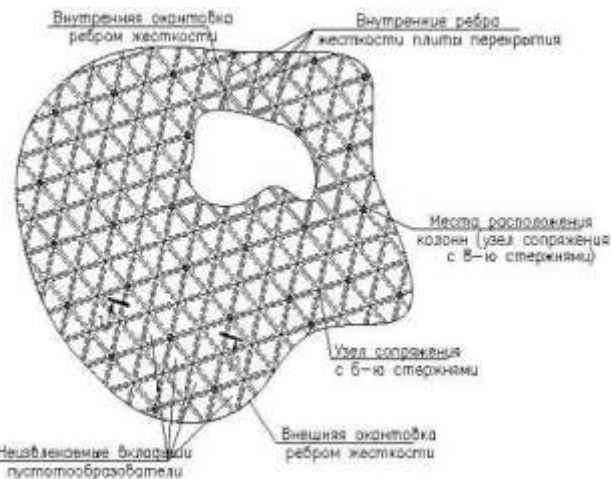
Конструкция плиты перекрытия с колоннами и внутренним отверстием
